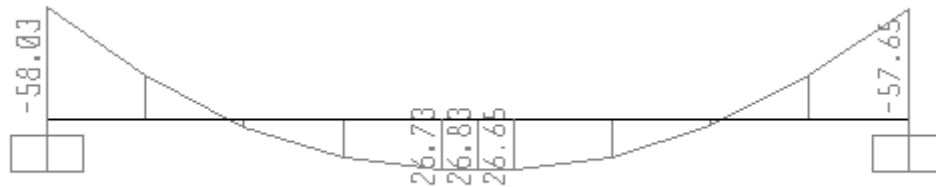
Sơ đồ tải trọng tác dụng lên dầm chiếu tới.
